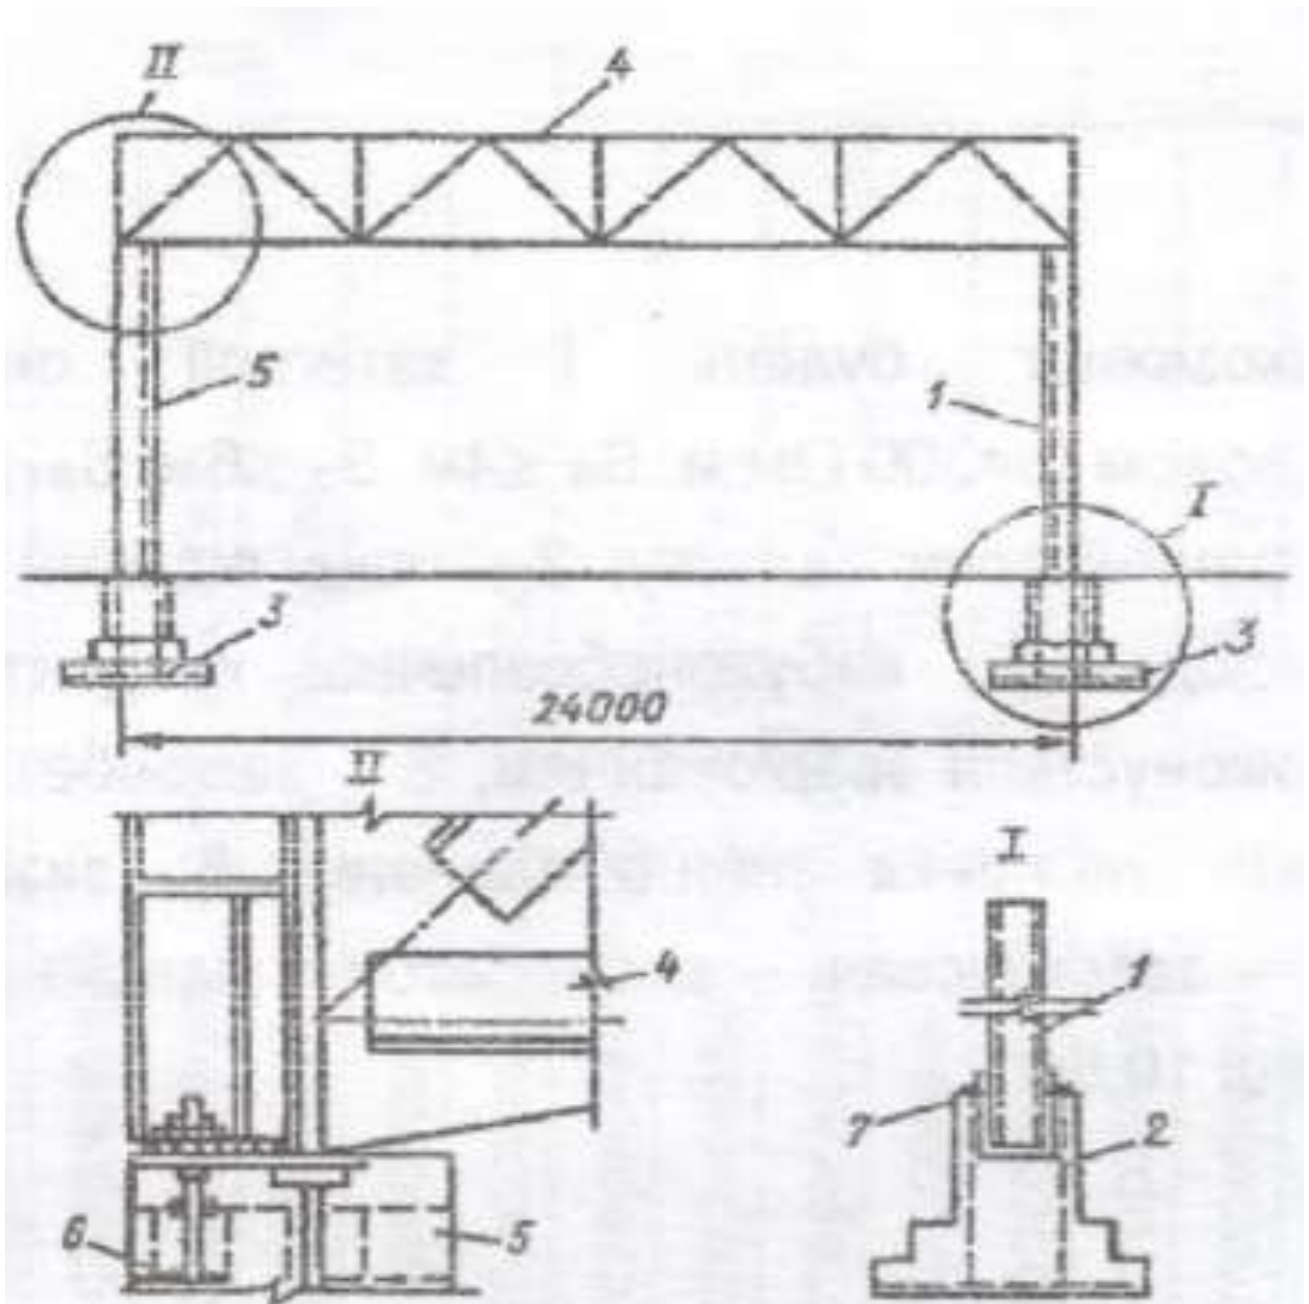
Блискавкозахист будівлі II категорії з металевими фермами (струмовідводами і уземлювачами є арматура залізобетонних колон і фундаментів): 1 – арматура колони; 2 – арматура фундаменту; 3 – уземлювач; 4 – металева ферма; 5 – залізобетонна колона; 6 – анкерні болти, які приварюються до арматури; 7 – закладна деталь
